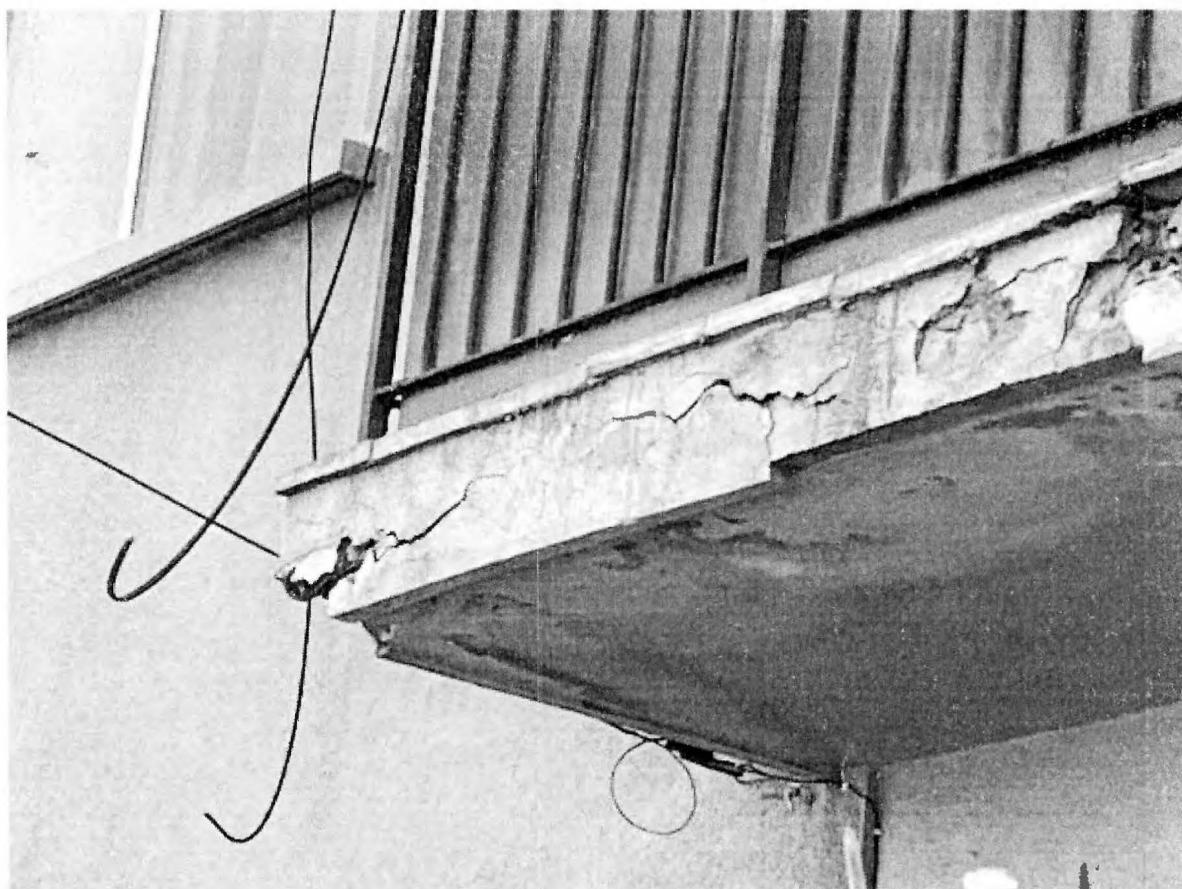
Desprendimiento de pintura y recubrimiento de hormigón en losas de balcones de fachada sur.
